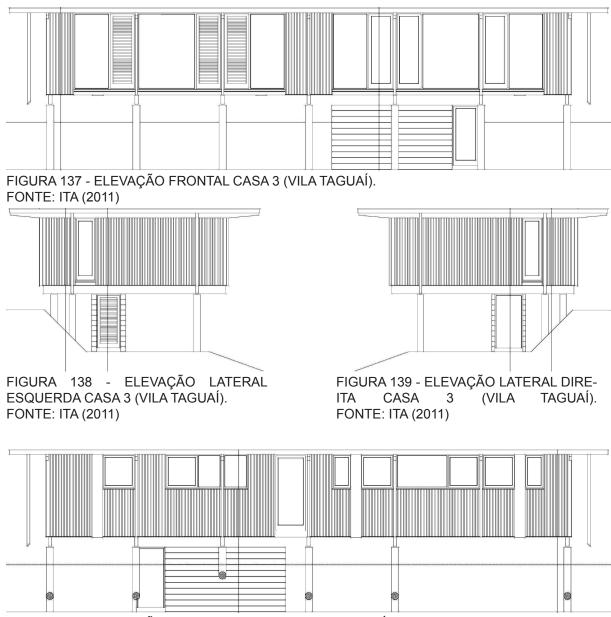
ELEVAÇÃO POSTERIOR CASA 3 (VILA TAGUAÍ). FONTE: ITA (2011)
